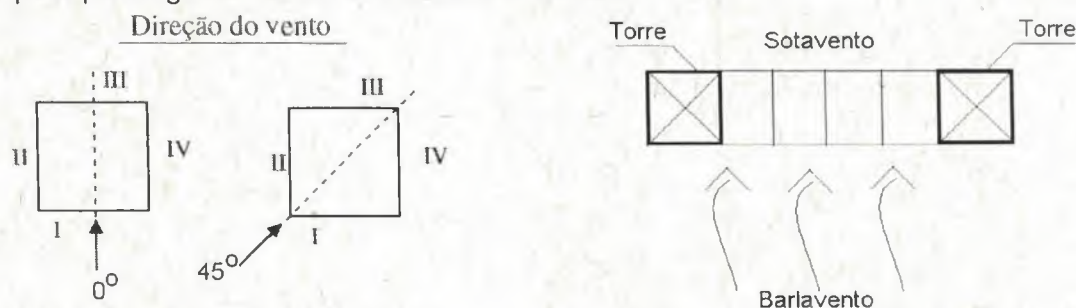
a) direções dos ventos simulados; b) indicação da face de barlavento e sotavento
